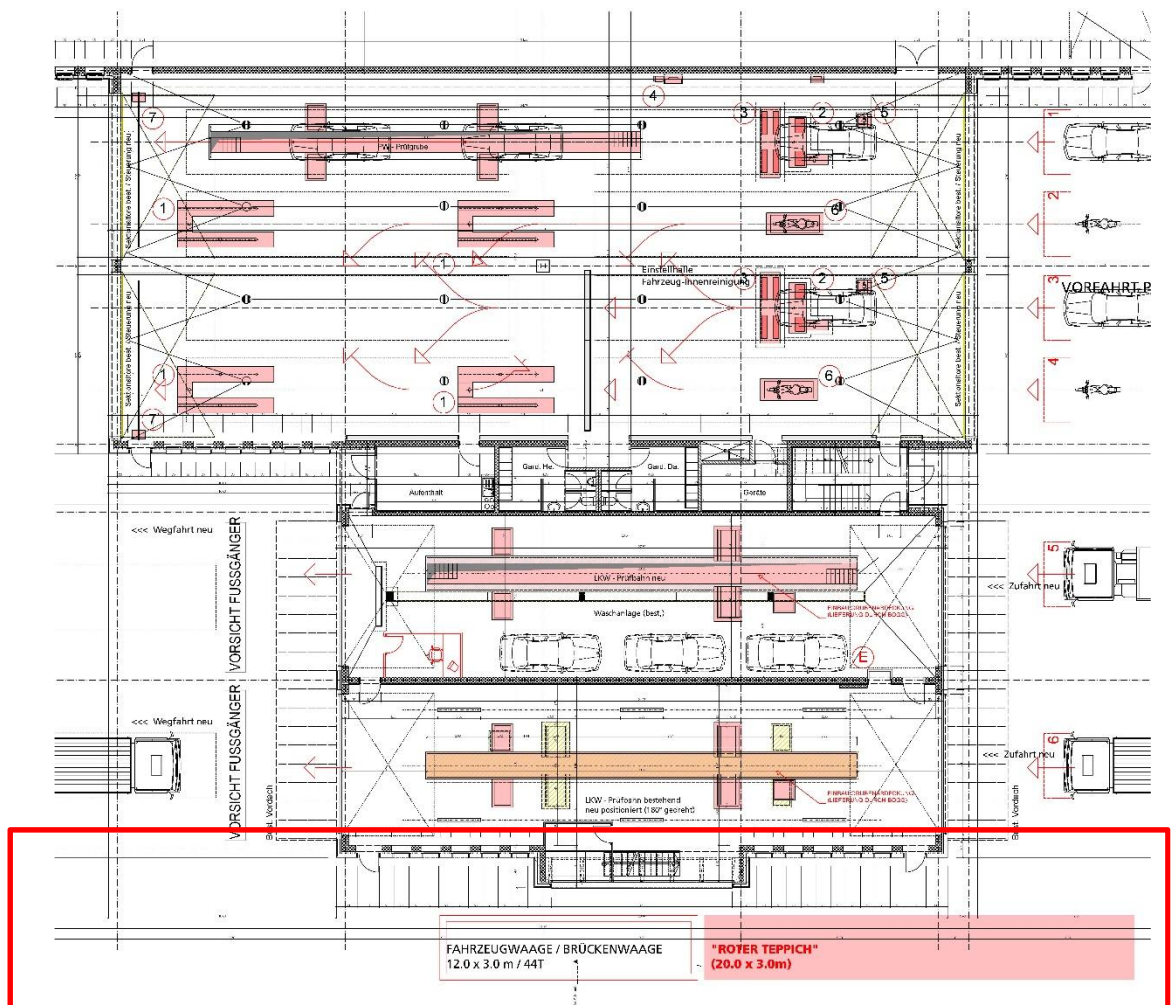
Grundrisslayout Fahrzeugwaage
